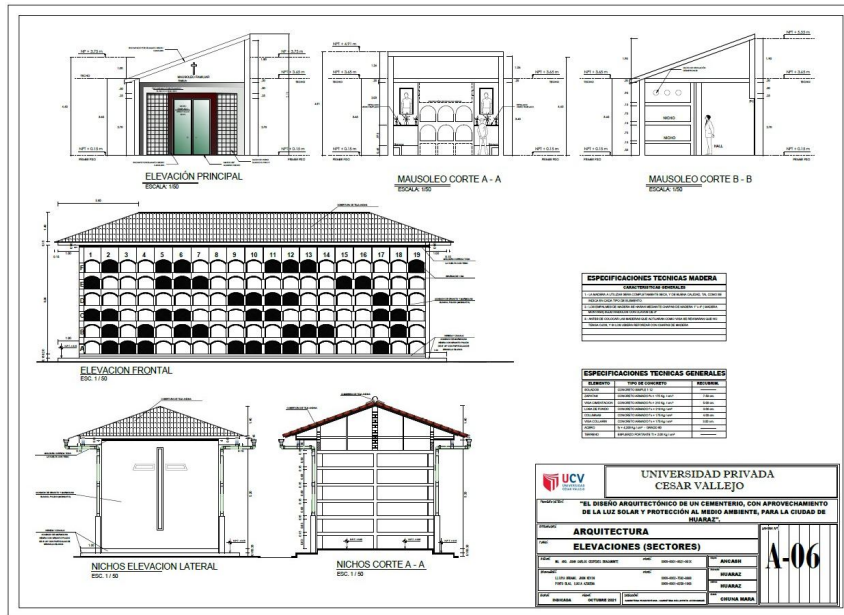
Plano Elevación Nivel 01: Sector 03 y 04.
